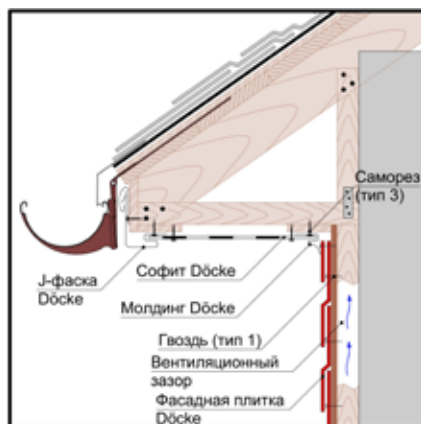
Примыкание фасадной плитки к карнизному свесу.
